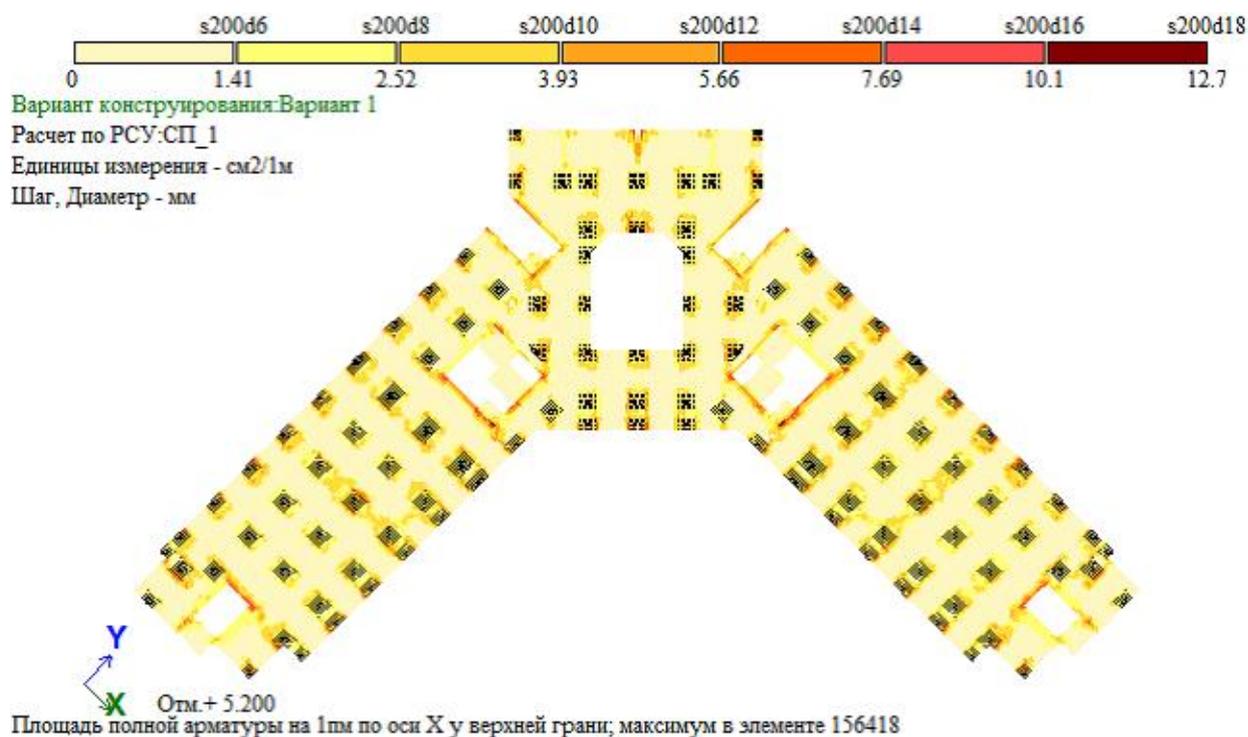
Армирование плиты на отм. +5.400. AS2 (верхняя по X1)
